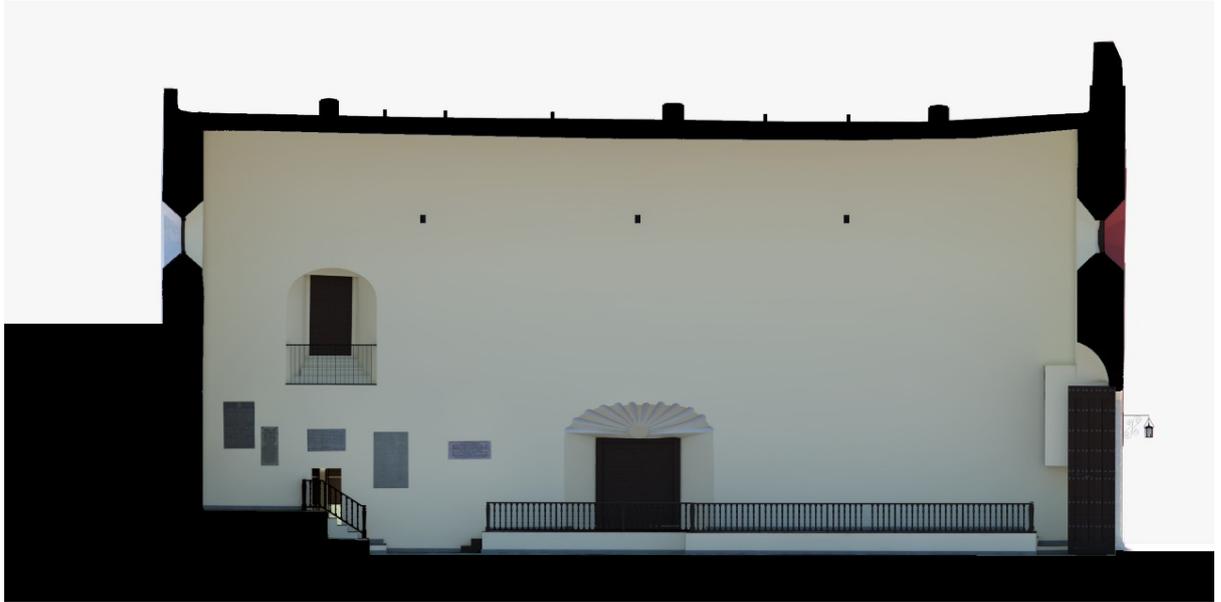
Sección transversal sur levantamiento (CDR)
